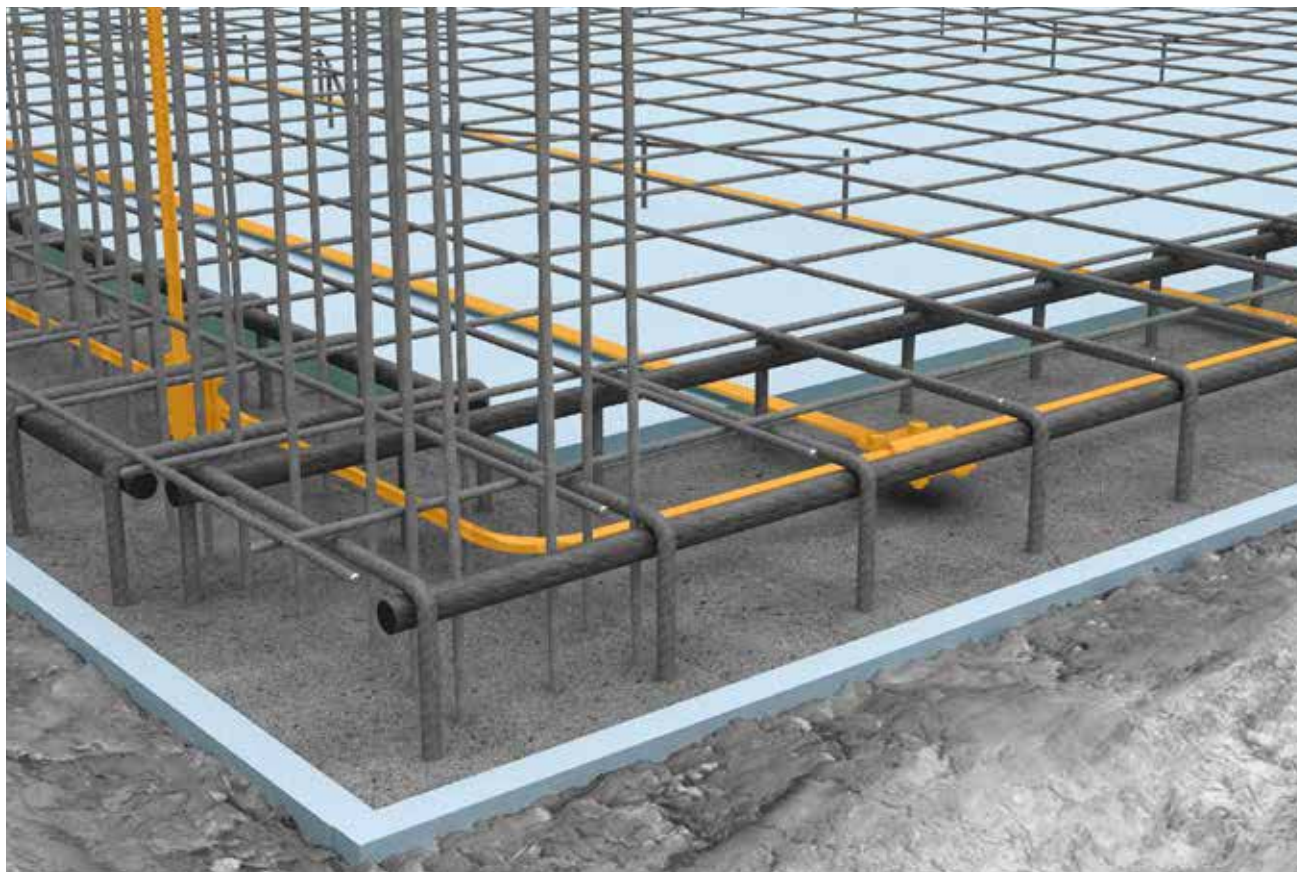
Изолированная фундаментная плита (изоляция по периметру, здесь: голубая)
